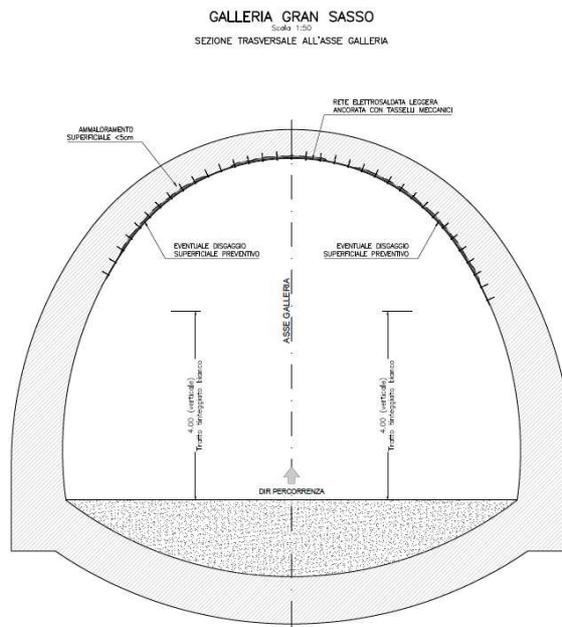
Rappresentazione tipologica su sezione trasversale galleria
